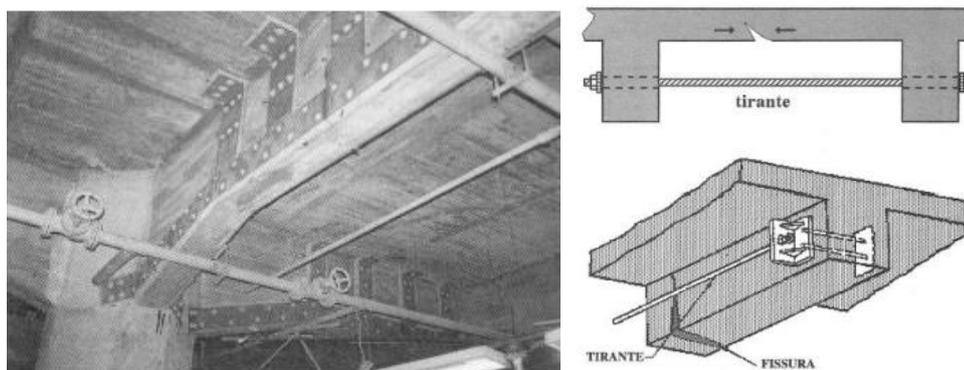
À esquerda exemplo de reforço com chapas metálicas chumbadas, à direita ilustração de costura de fissuras a partir da utilização de protensão.
